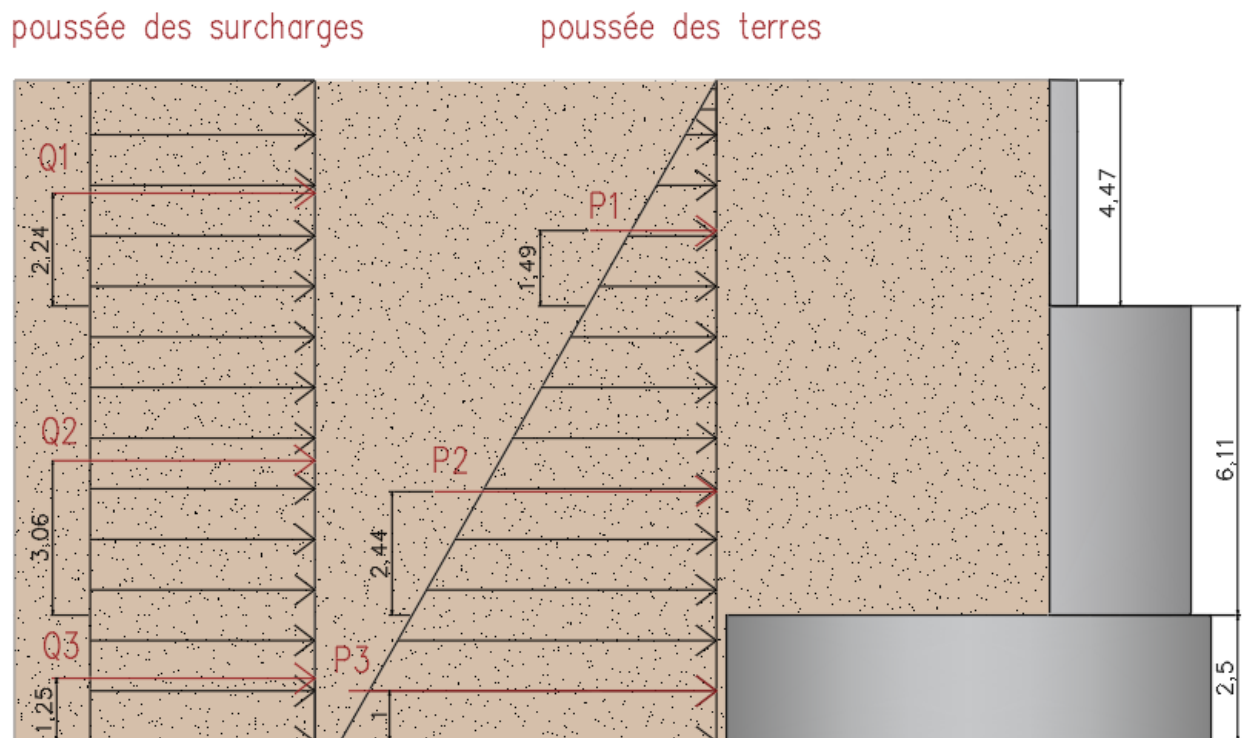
Poussées des terres du au mur garde-grève, mur frontal et la semelle
